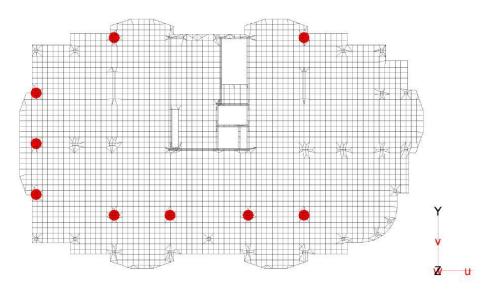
Расчётная схема плиты при расчёте на продавливание
